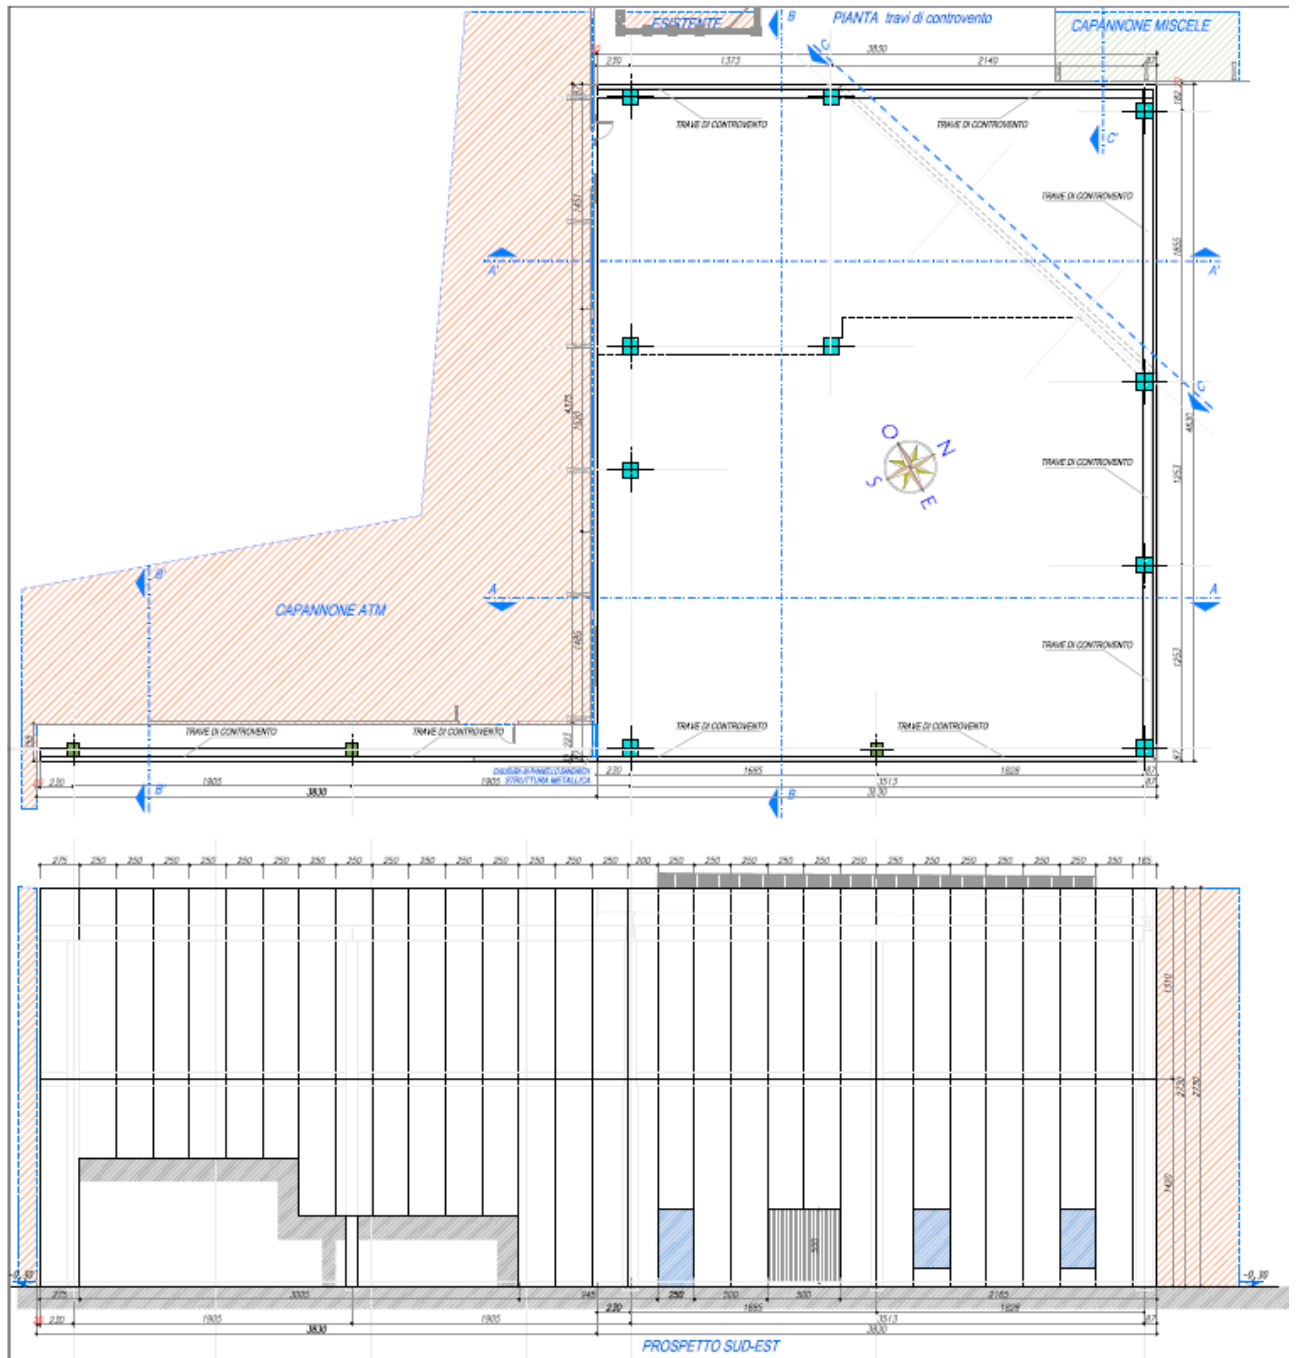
i - Ampliamento capannone impasti – pianta e prospetto
